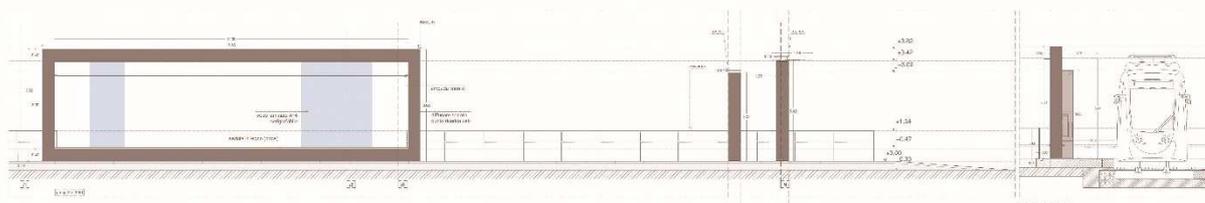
Pensilina di fermata – Prospetto e sezione trasversale
